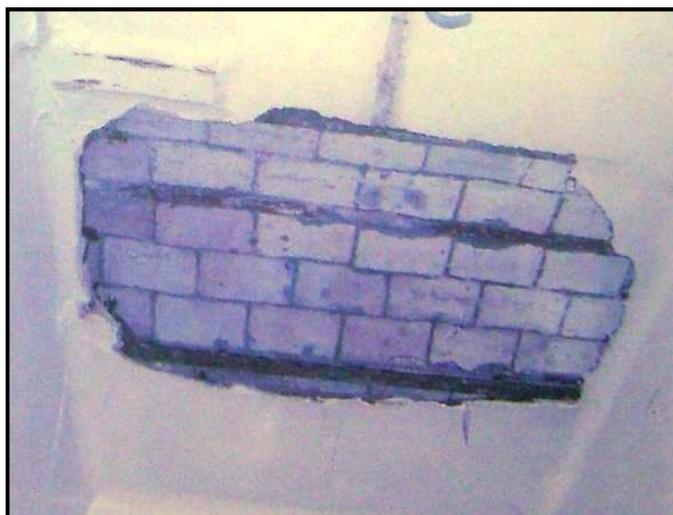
117 : Plancher du premier étage : en briques pleines supporté par des poutrelles métalliques. Source : le propriétaire de la maison.
